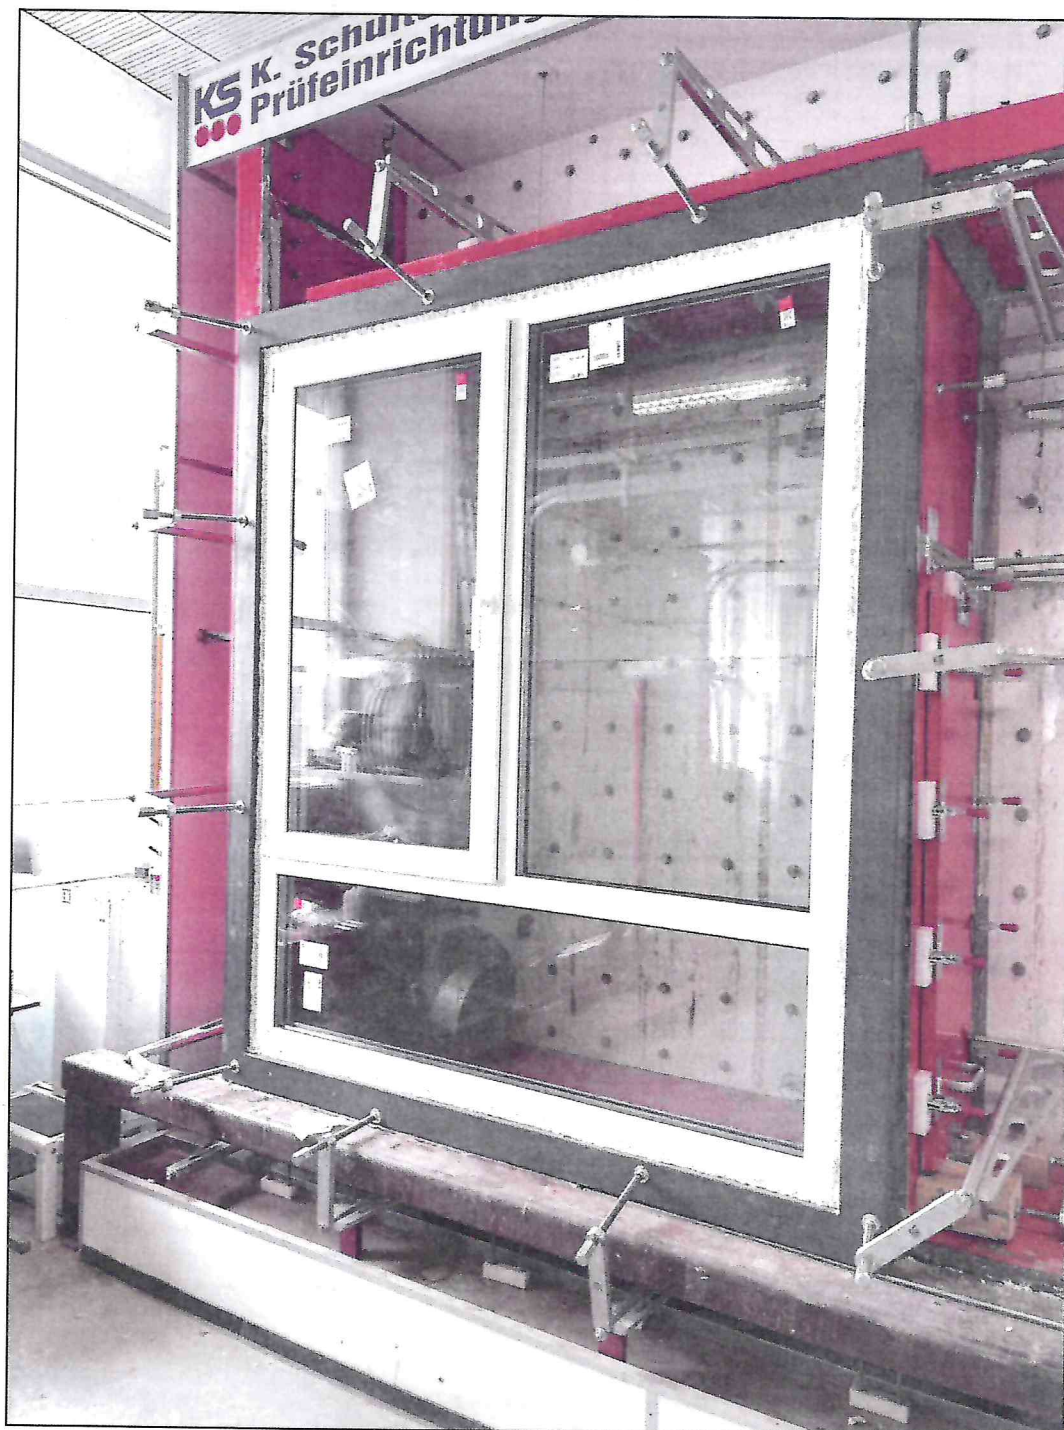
Образец 994-24-1, установленный на испытательный стенд
